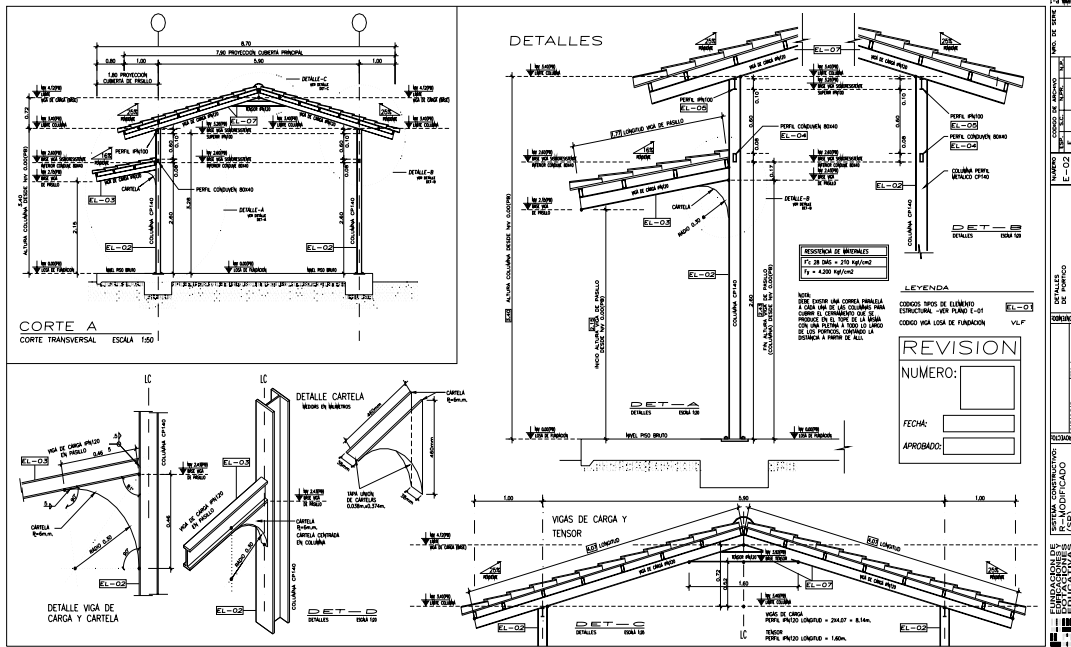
Detalles de pórticos. Sistema Rural
